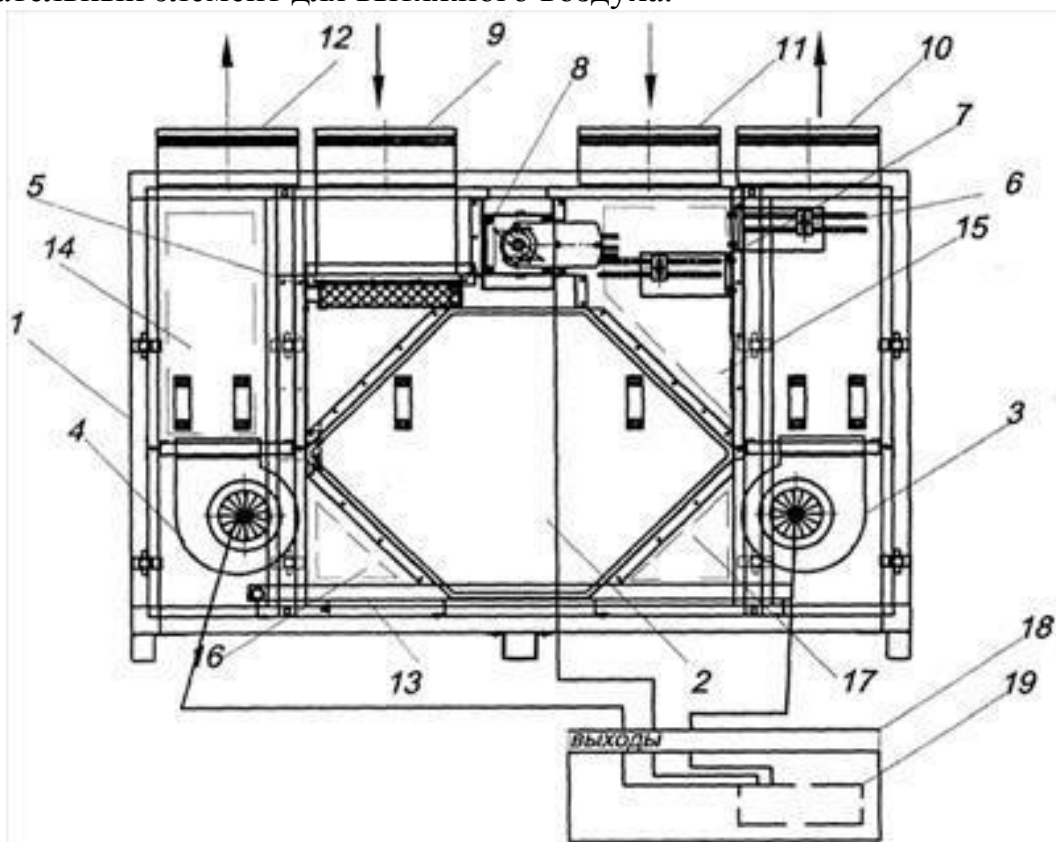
Приточно-вытяжная установка с пластинчатым рекуперативным теплоутилизатором
